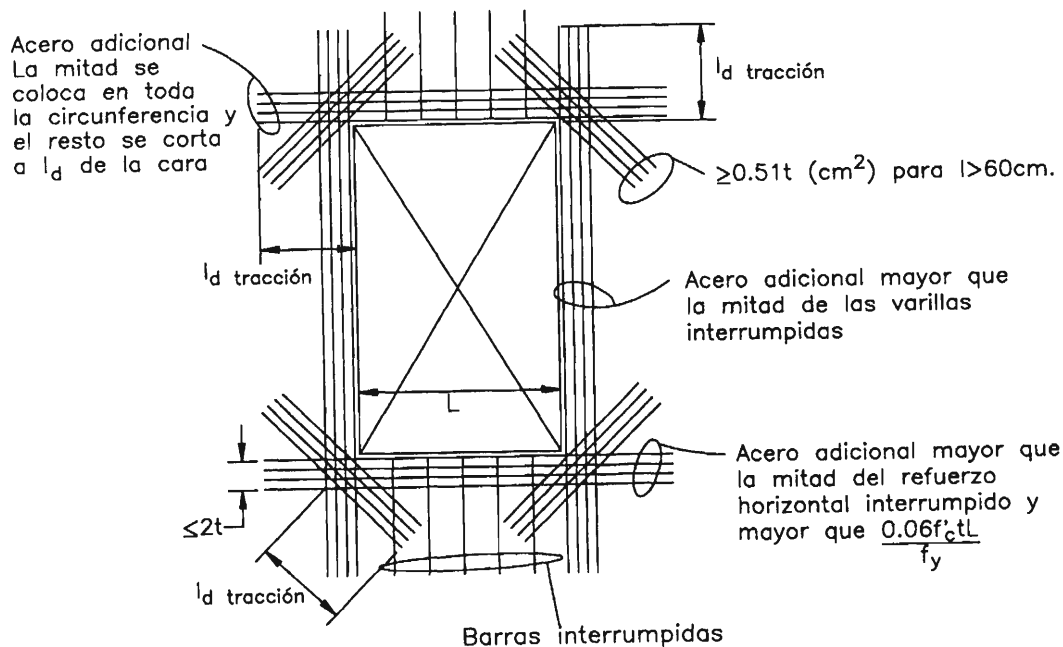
Refuerzo adicional colocado alrededor de las aberturas de la chimenea
